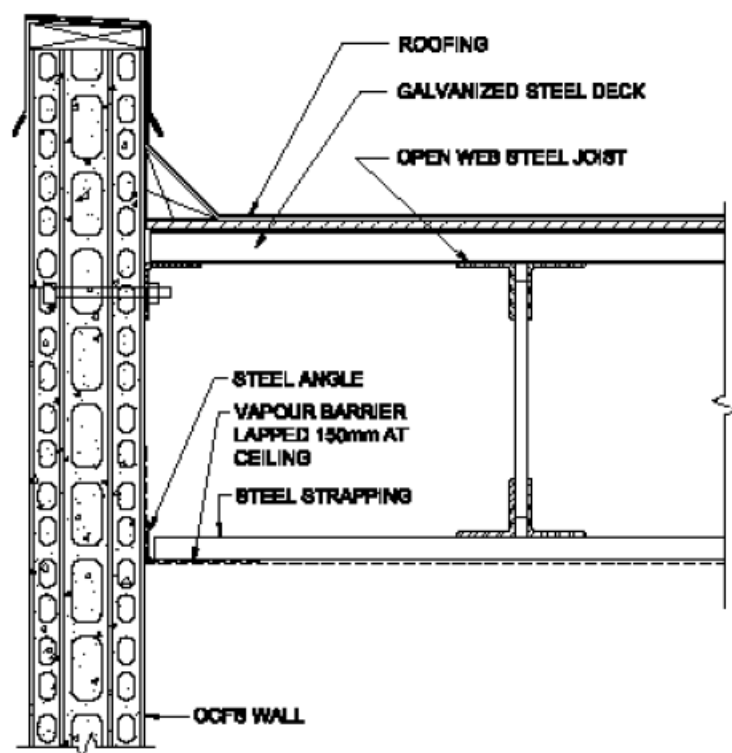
Detalhe da ligação da parede com teto metálico a meio da parede
